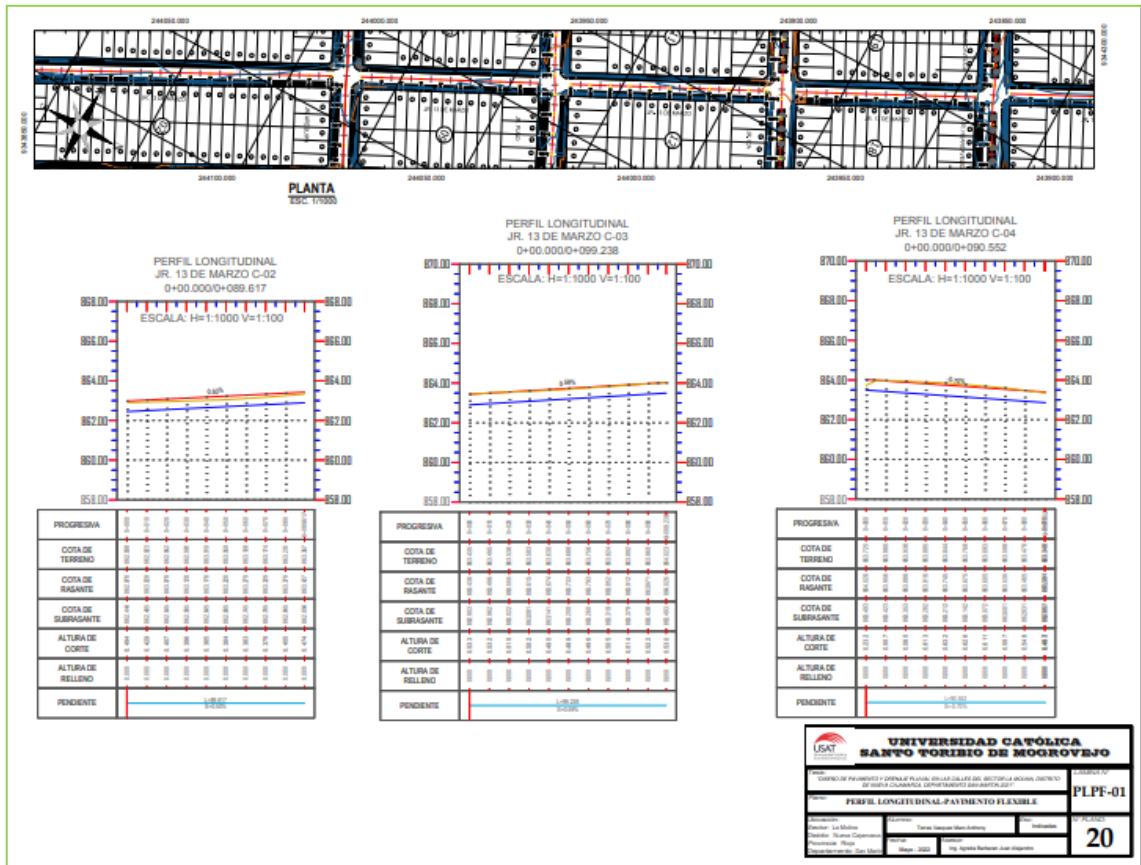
Perfil Longitudinal Jr. 13 de marzo
